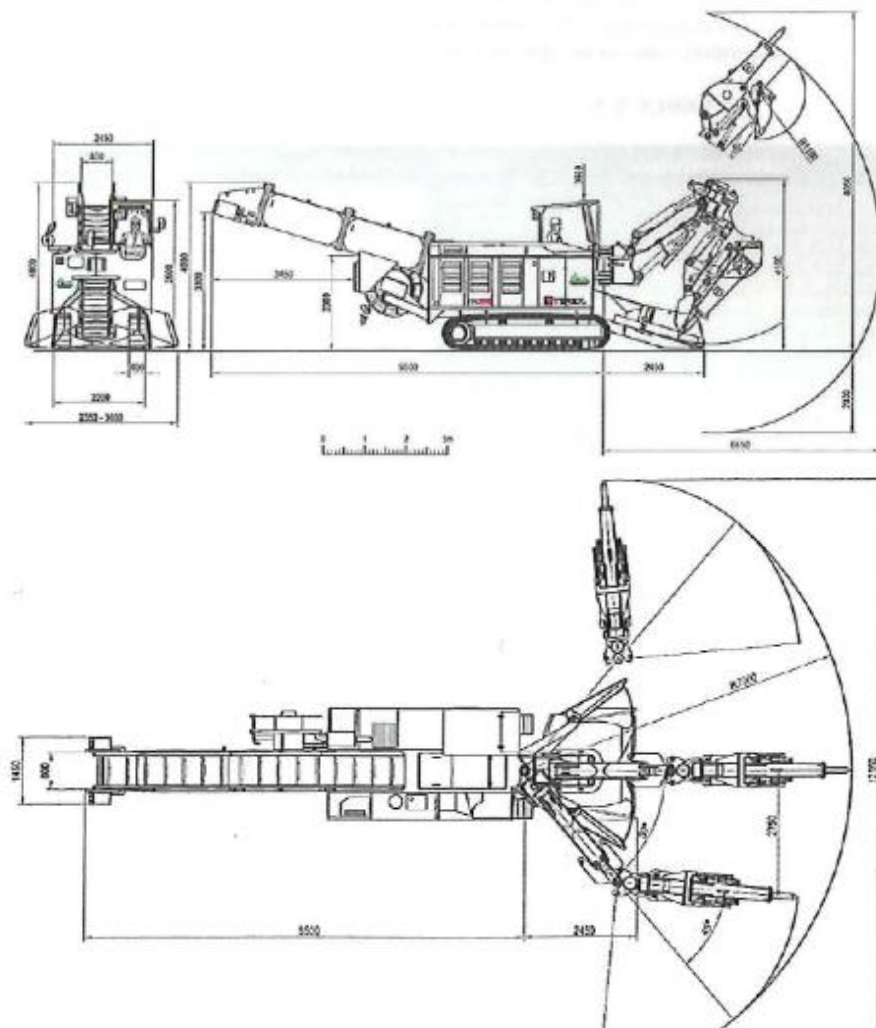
51: Máquina retroexcavadora con descarga. (C. López Jimeno et al., 2013)
